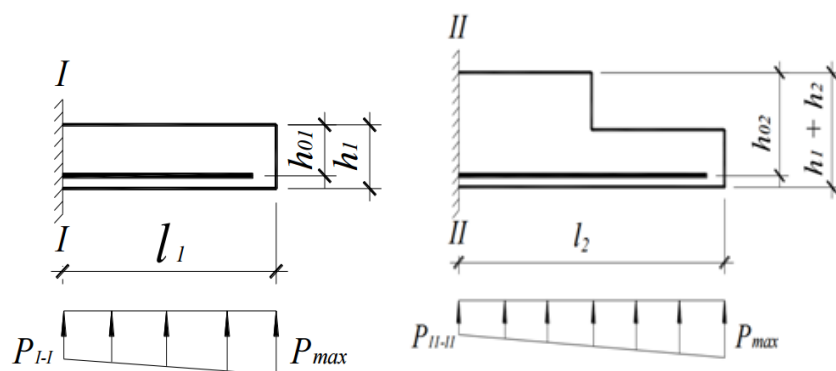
Схемы для расчета арматуры в сечениях I-I, II-II
